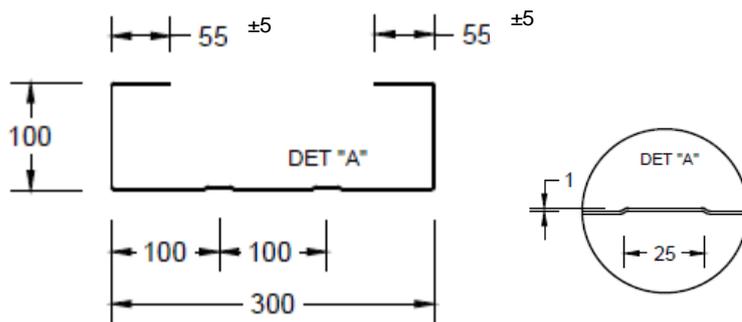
Módulos metálicos do sistema construtivo Steel Panel Quick House
